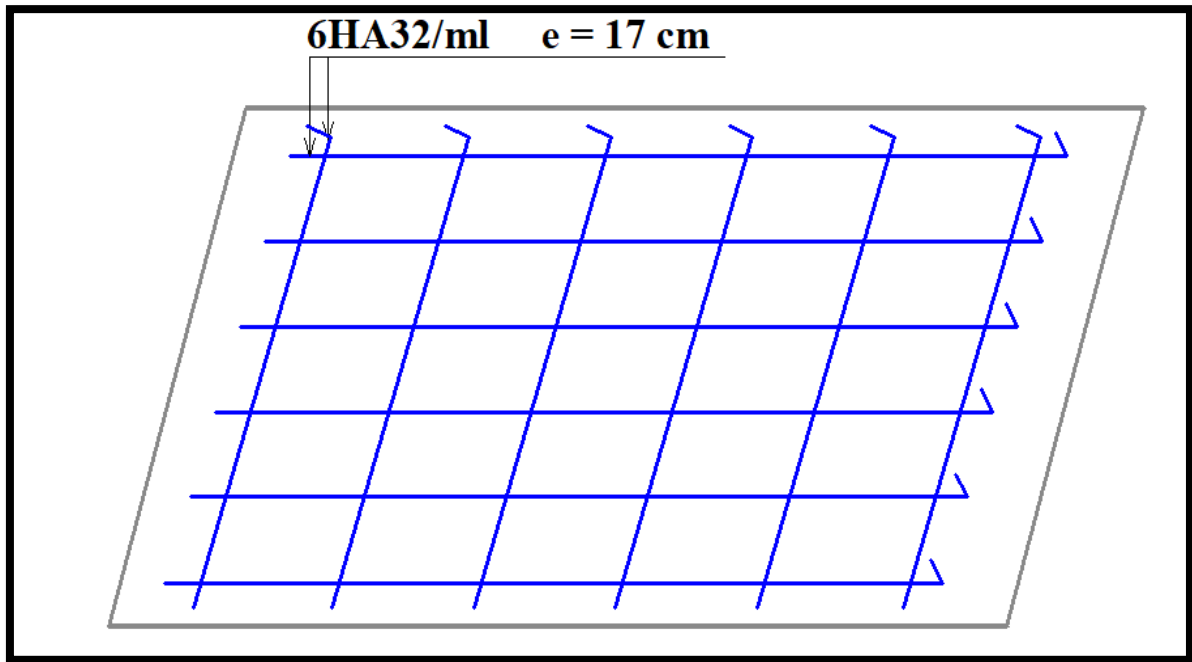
Ferrailage de la nappe inférieure du tablier
